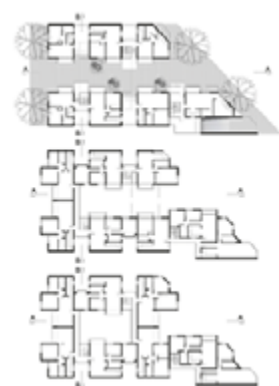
Plantas del conjunto. Fuente: La Plata Arquitectura Moderna.
